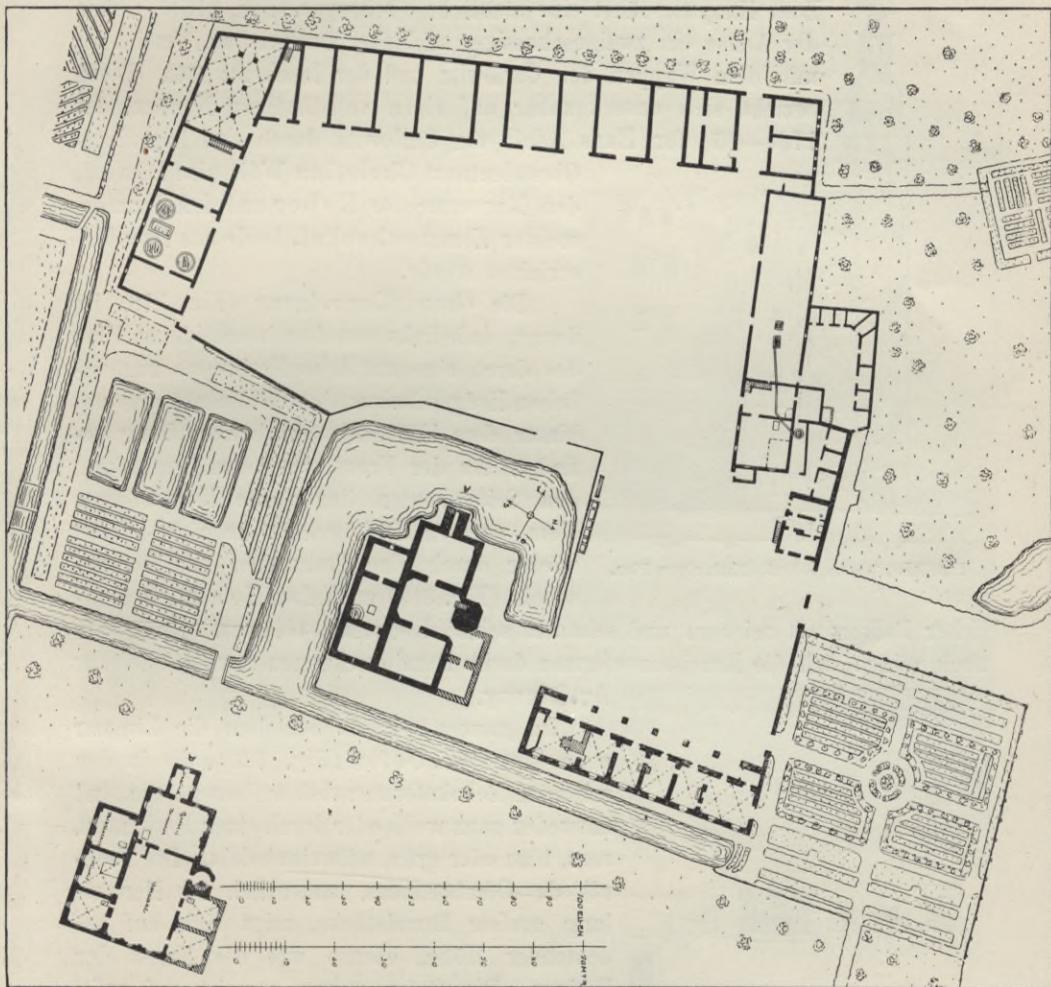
Stösitz, Schloß, Grundriß. Nach altem Plan.
